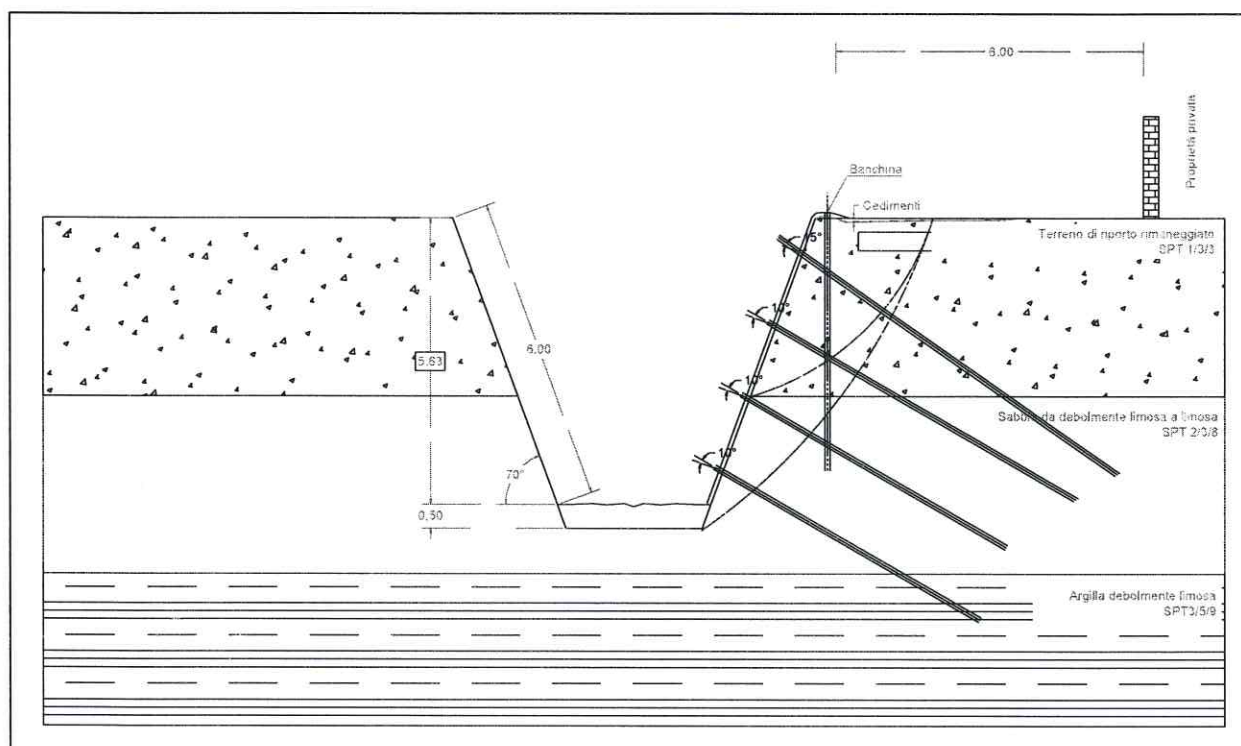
Sezione tipo consolidamento mediante parete chiodata verde
